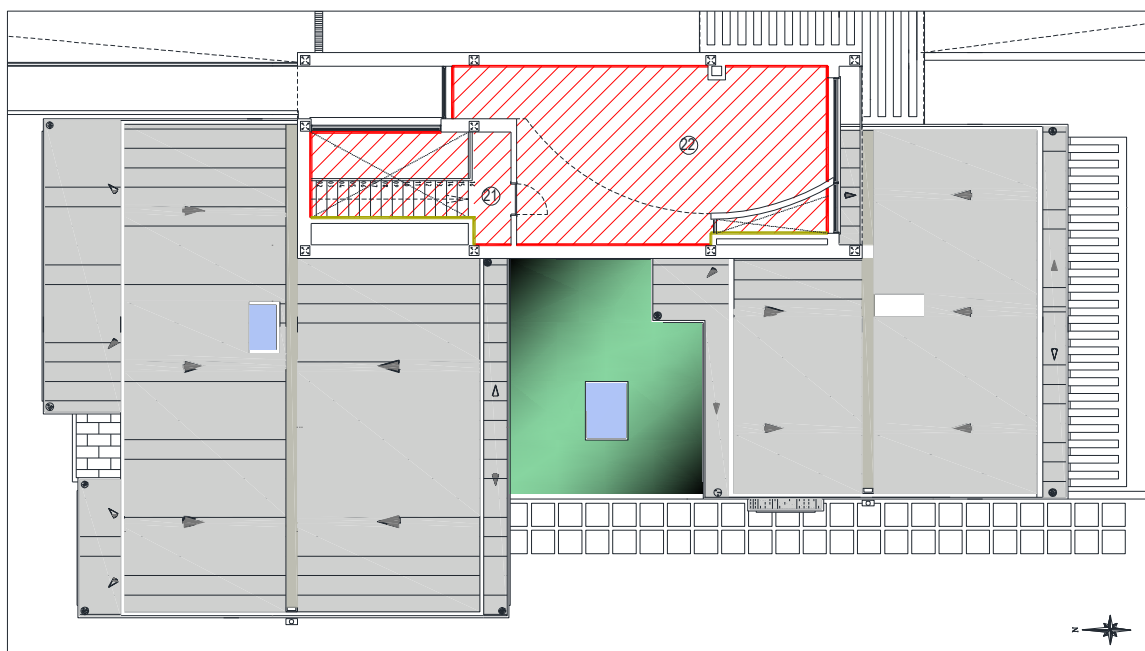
Planta do piso 1 com a delimitação da envolvente ao nível do teto.
